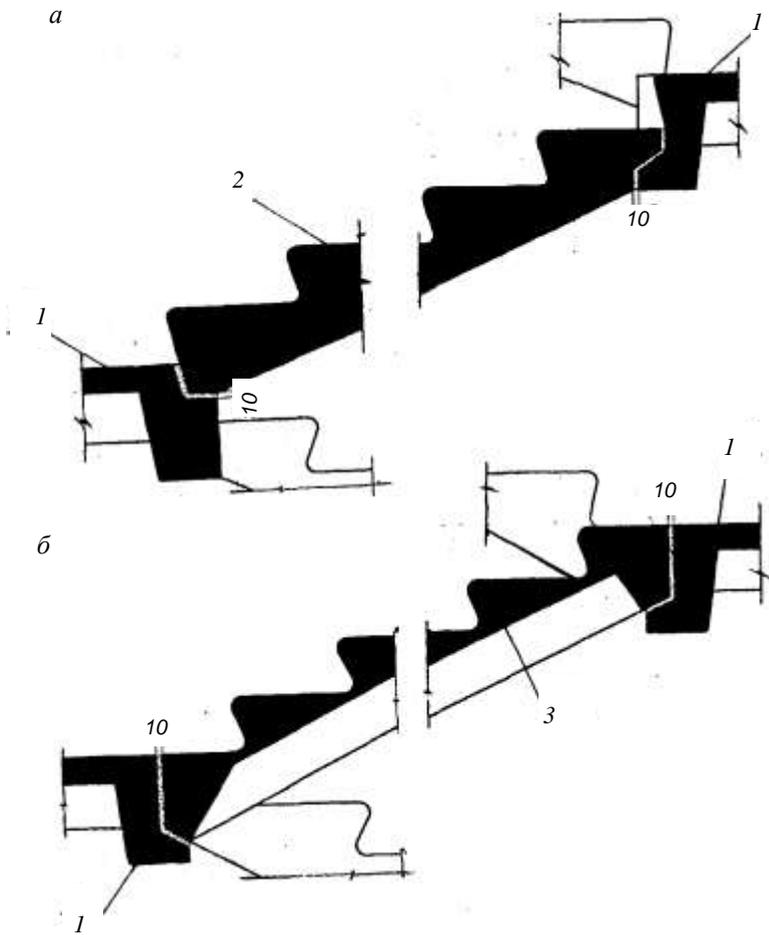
Конструкции лестниц: *a* — с маршем без фризových ступеней; *б* — с маршем с фризowymi ступенями; 1 — лестничная площадка; 2 — марш сплошной конструкции; 3 — марш ребристой конструкции
